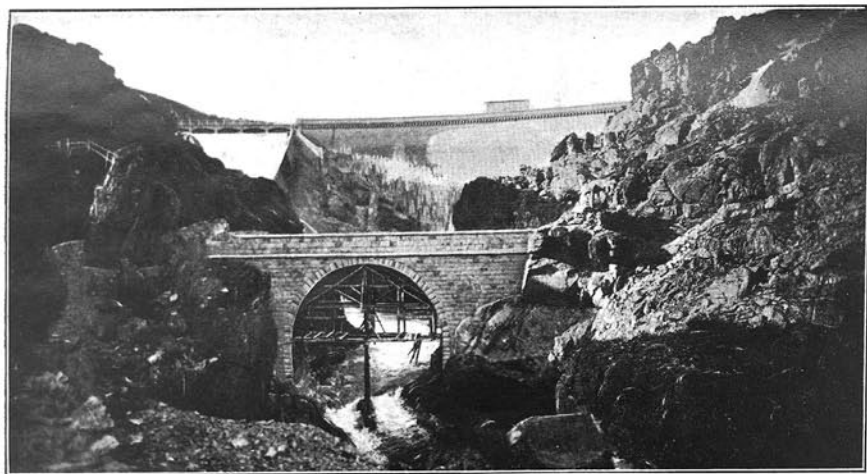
Origen del Canal transversal. Puente acueducto sobre el Lozoya.
